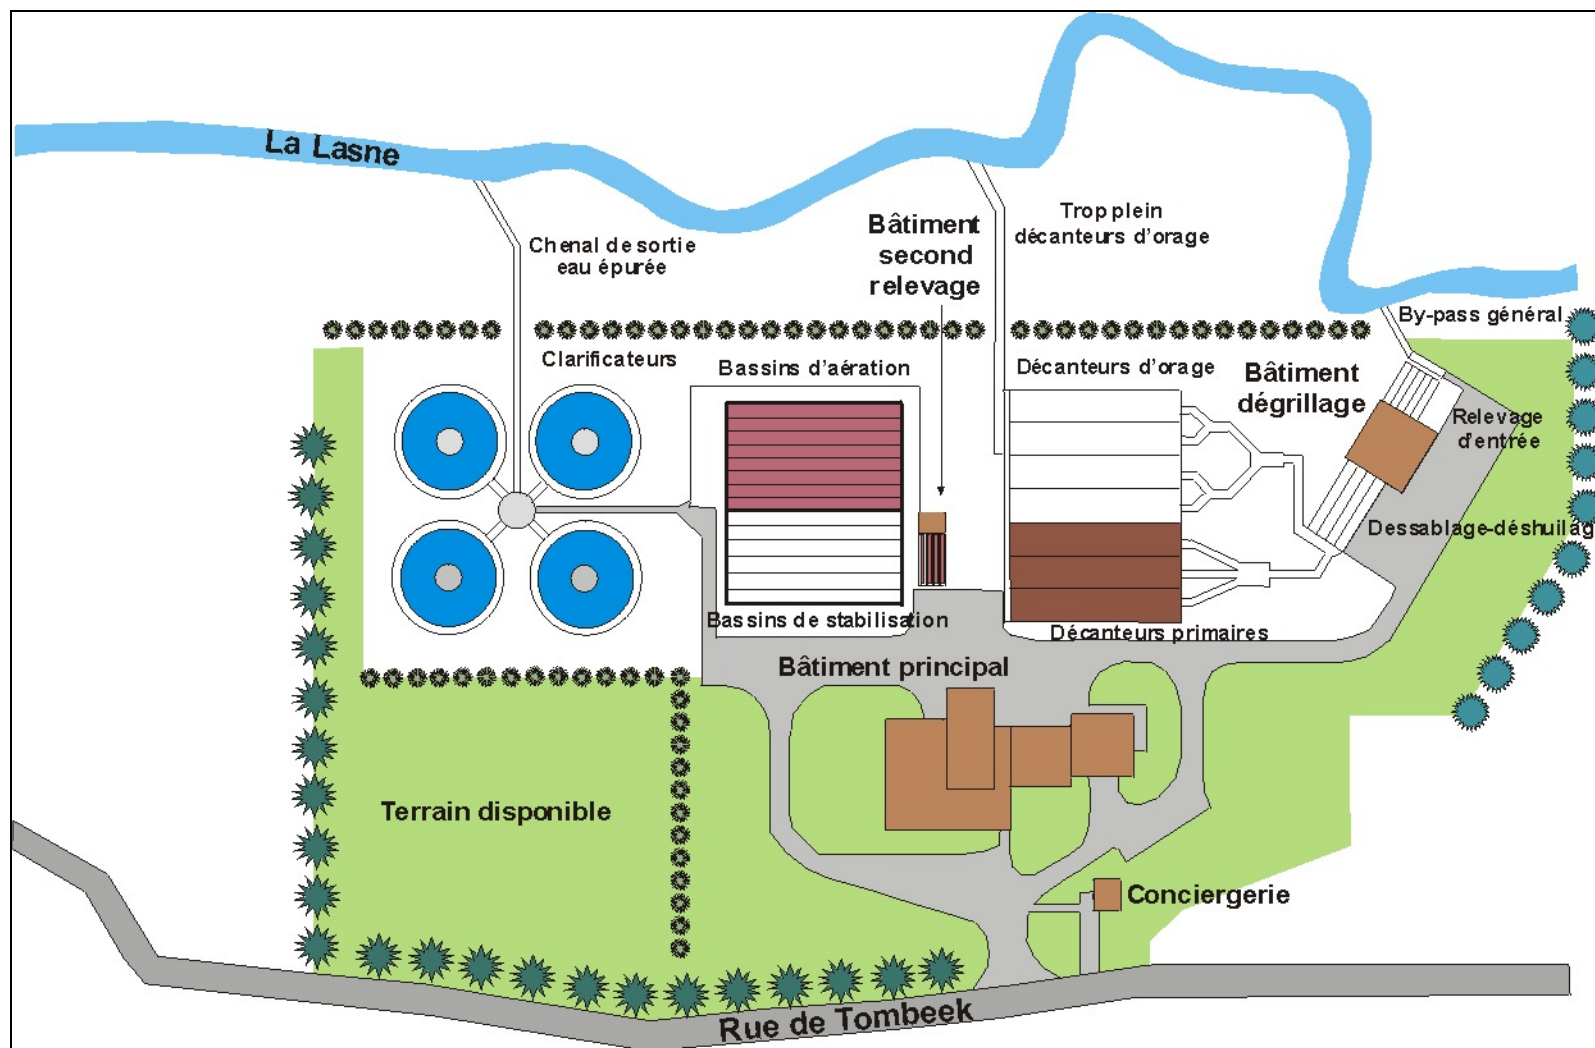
station d'épuration de la Lasne: plan d'implantation actuelle
